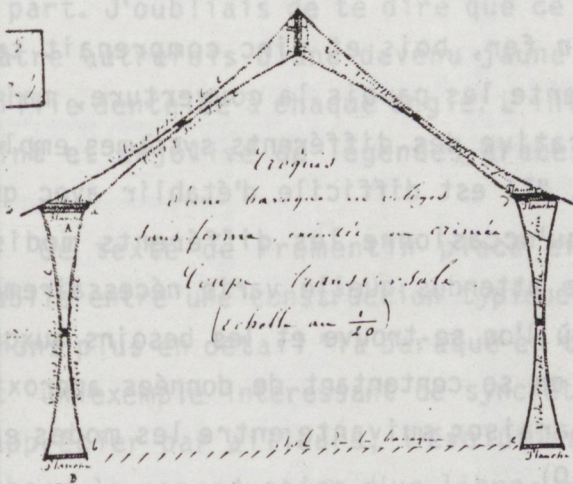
Pavillon d'isolement pour malades, par M. O. André. Coupe transversale.
